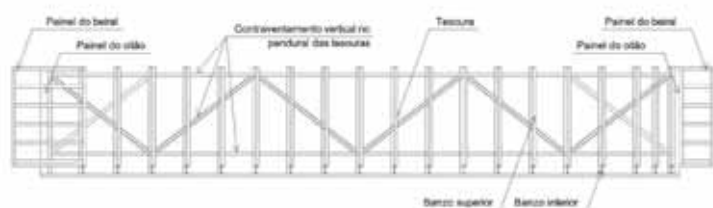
Vista lateral de estrutura de telhado mostrando o contraventamento em “X” do sistema de tesouras.
